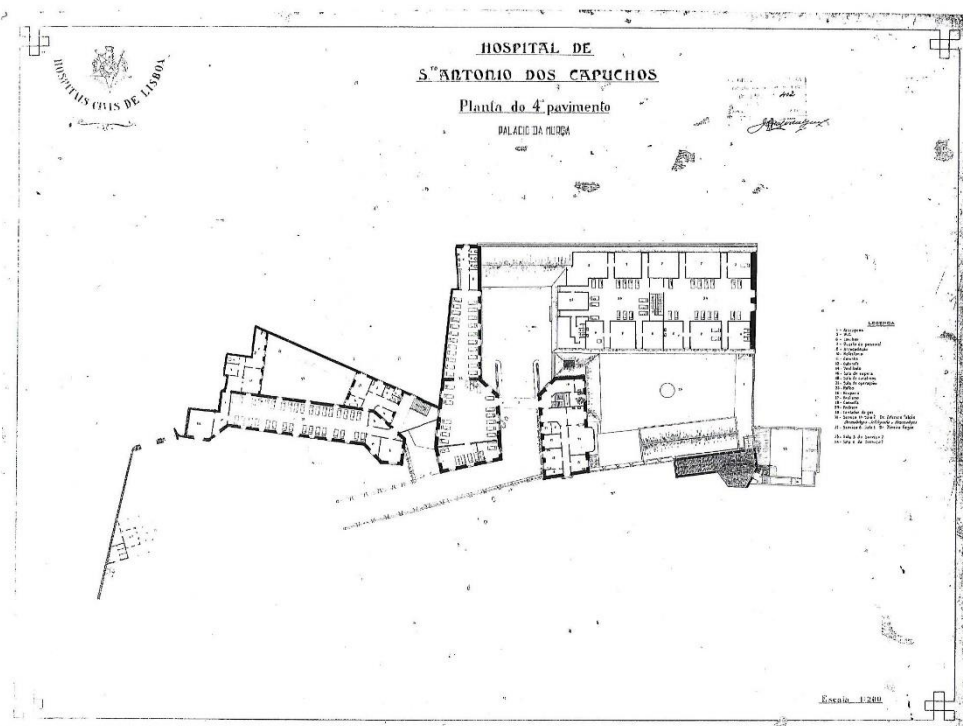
Planta do Antigo Palácio Murça - 4º Pavimento (DGPC/SIPA, Cota: DES 00028069)
